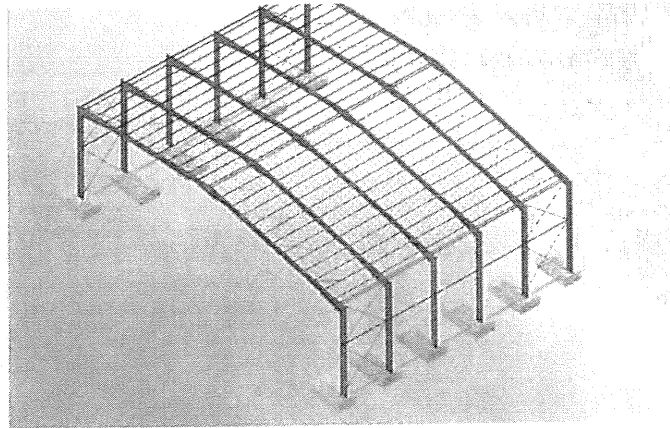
infografía de la estructura y cubierta metálica a colocar
